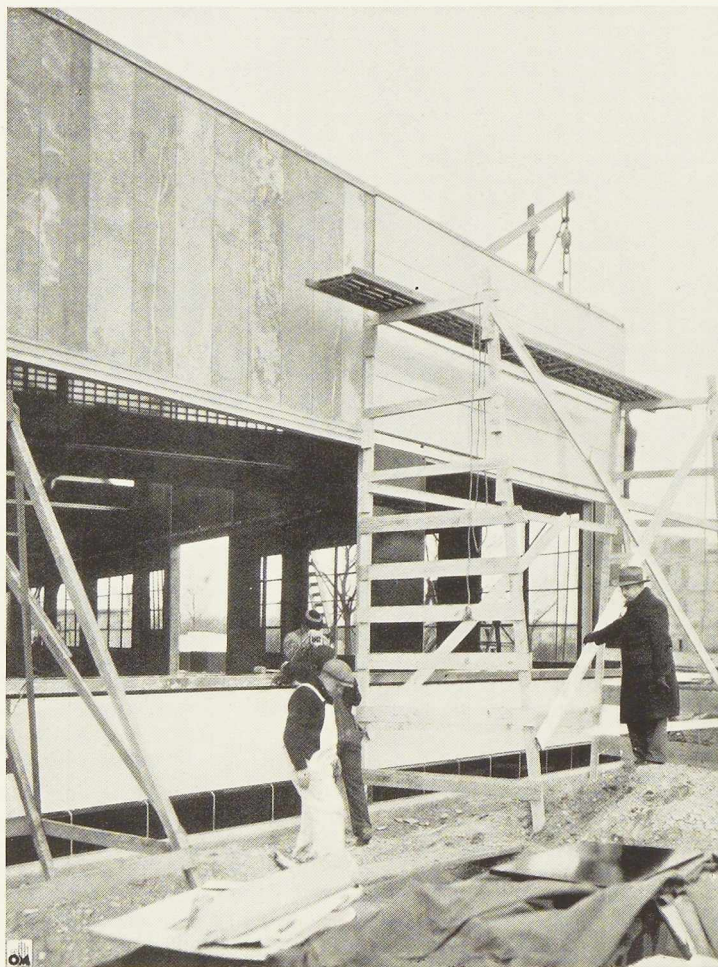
Montage des panneaux métalliques constituant la partie extérieure du mur.
